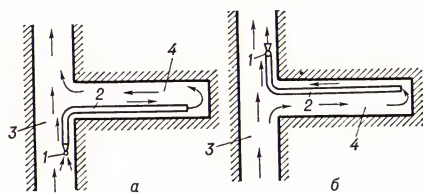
Схемы вентиляции тупиковых выработок: а — нагнетательная; б — всасывающая; 1 — вентилятор; 2 — трубопровод; 3 — сквозная выработка; 4 — тупиковая выработка.
